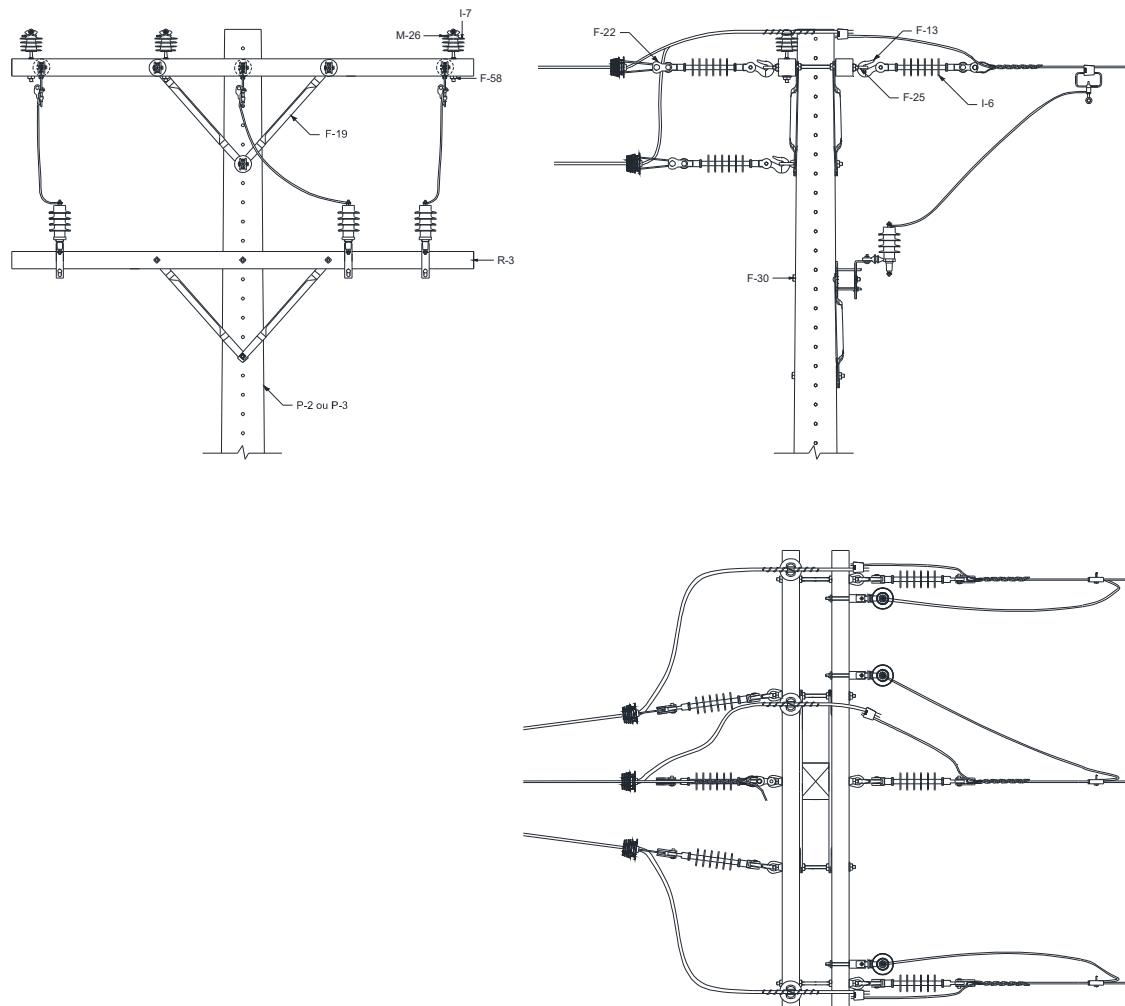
Estruturas especiais – Estrutura N3-C3A
